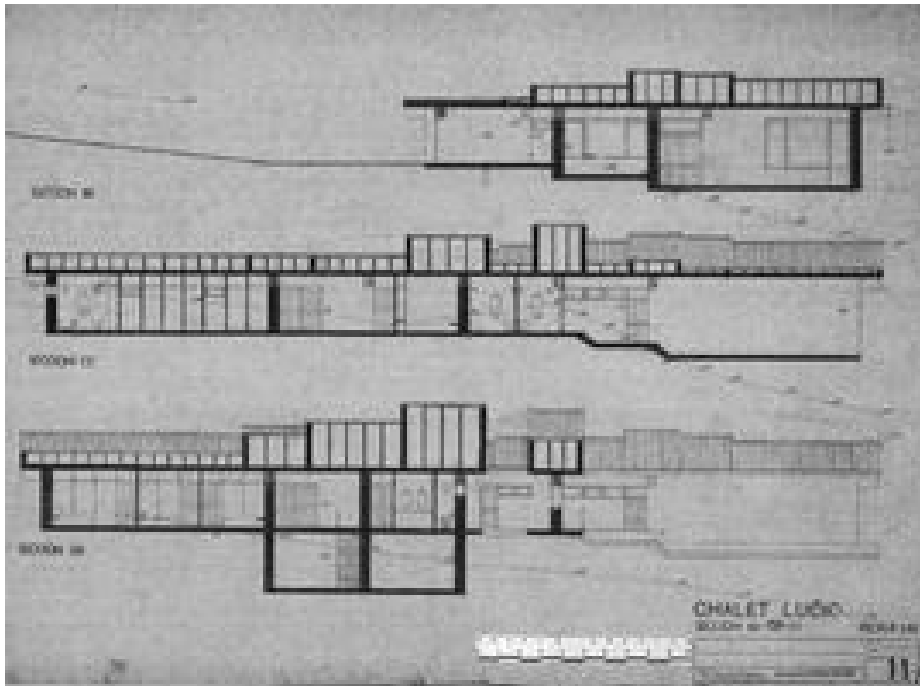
Secciones longitudinales y transversal de la Casa Lucio Muñoz.
